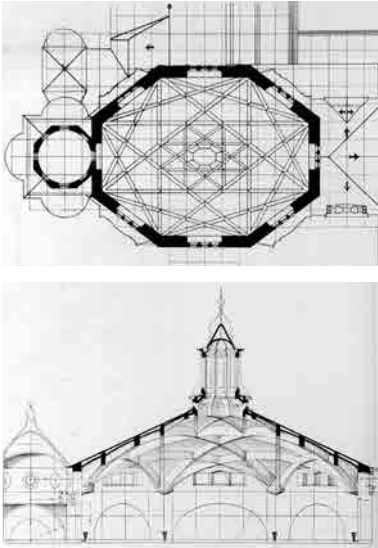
y Fig. 40 Cubierte de la capilla. Planta (arriba) y sección (abajo).
